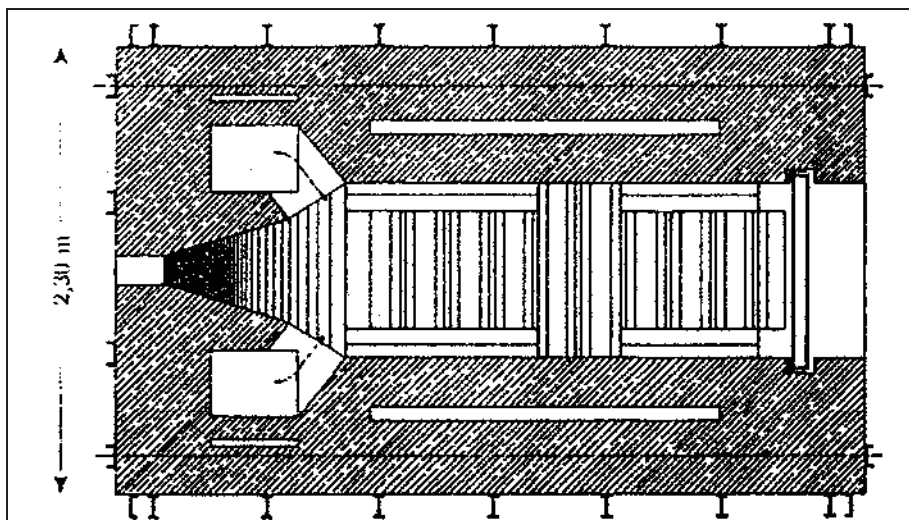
Grundriß A—B durch den Einäscherungsraum.
